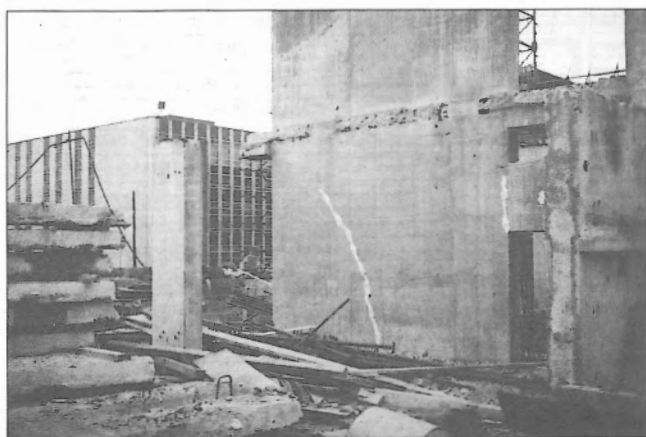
Pohled na rozestavěnou nadzemní část nosné konstrukce
